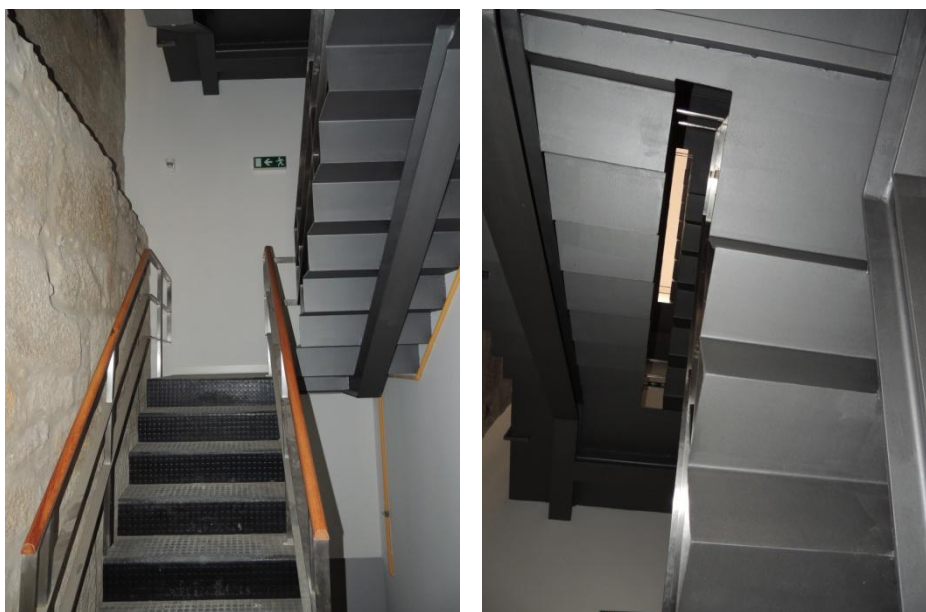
Escada com estrutura metálica aplicada na Operação E1 - Projeto 8
